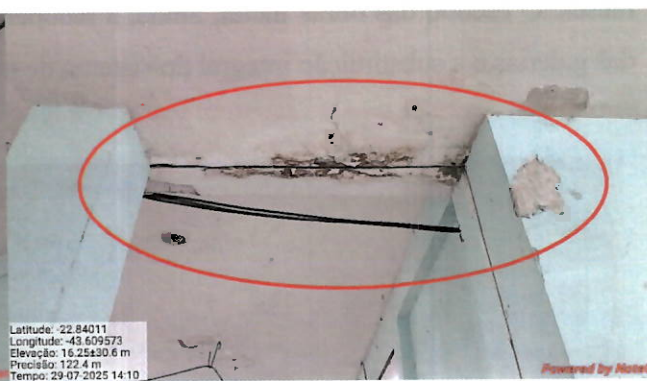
Teto das galerias com infiltrações (também passarão por reformas).
